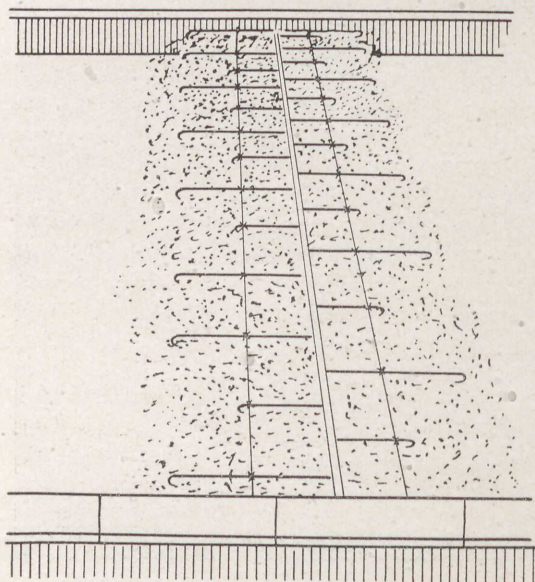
Befestigung der Kantenschutzzeisen in der Betondecke
